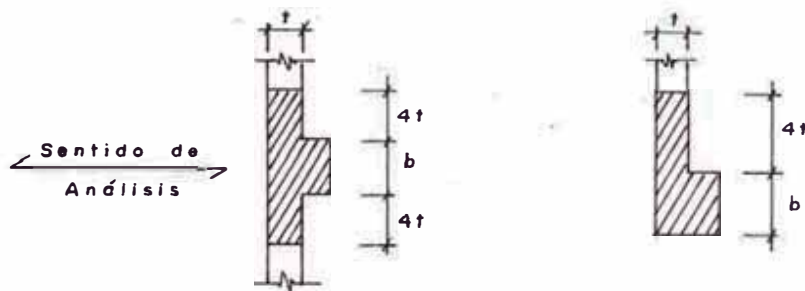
Sección efectiva de columnas contenidas en placas.
